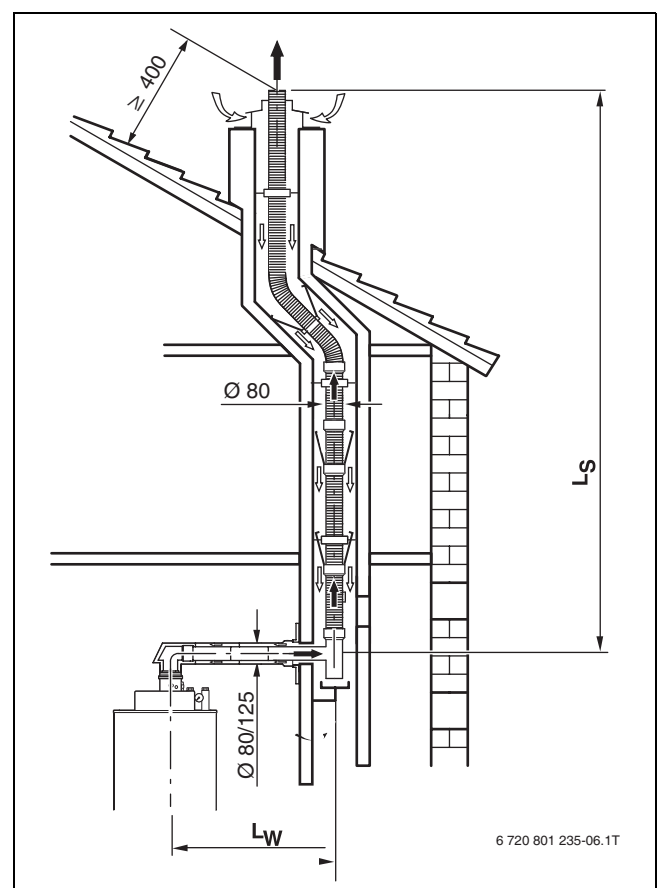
Abgasführung im Schacht, flexibel ($C_{93(x)}$)
